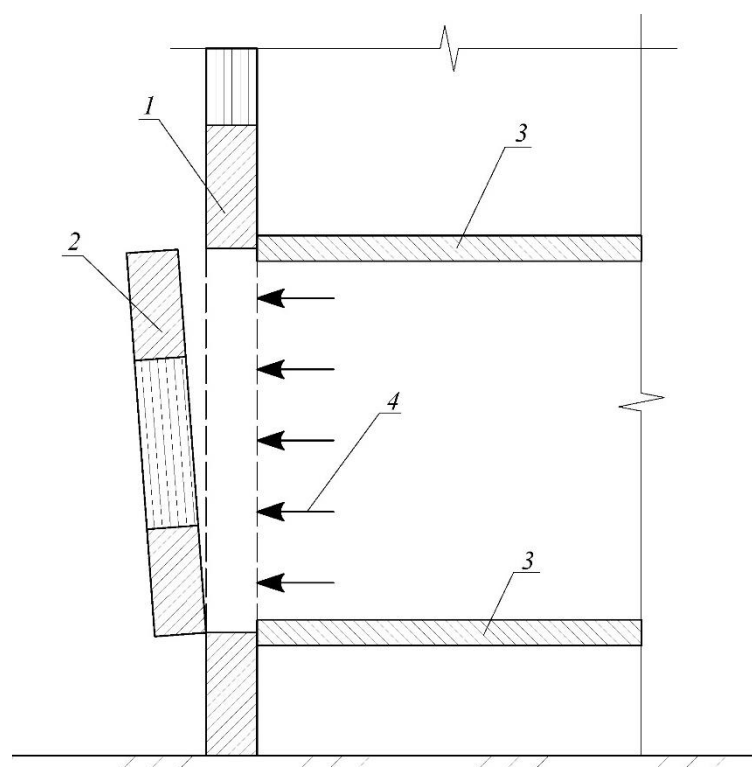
Принципиальная схема дефекта – смещение панели из плоскости стены: 1 – нормальное положение стеновой панели; 2 – смещение панели из плоскости стены (показано условно); 3 – перекрытие, 4 – направление смещения.
